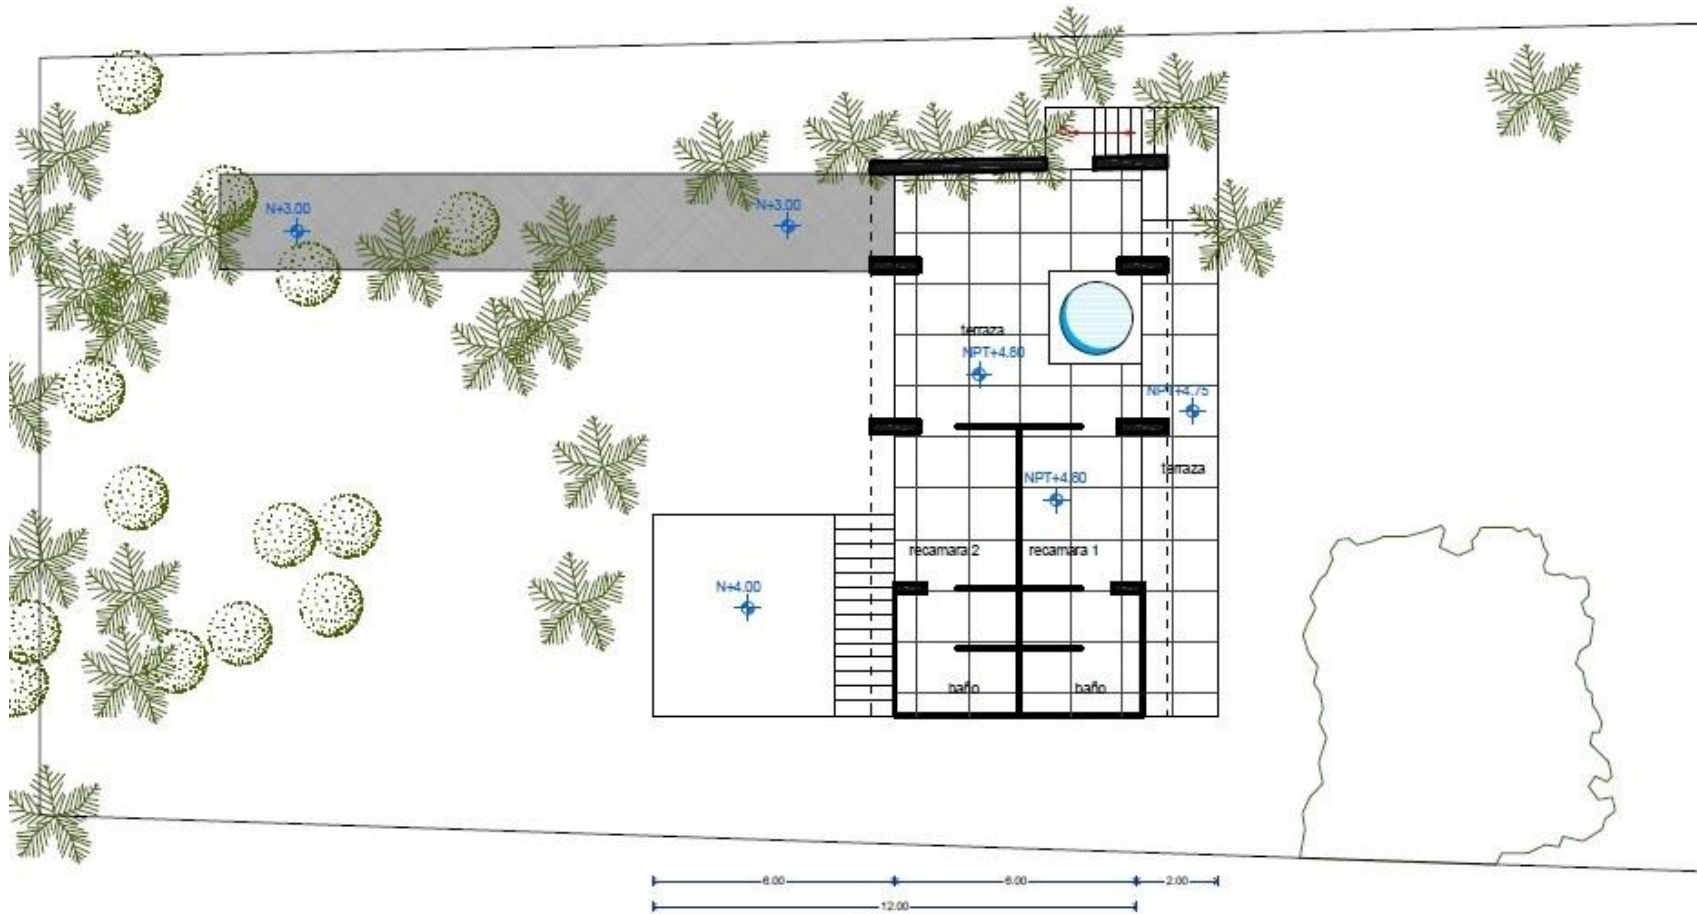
Plan maestro la casa habitación (Planta Alta).
